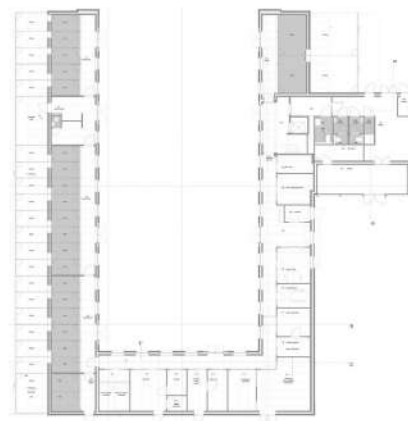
Планування притулку для тварин у м. Ломмелі, Бельгія, арх. бюро Collectief Noord, 2017 р. [33]
